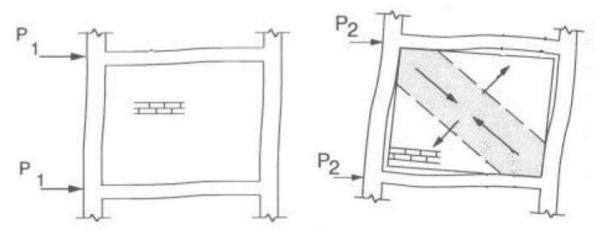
Ejemplo de un Muro confinado y su comportamiento estructural
